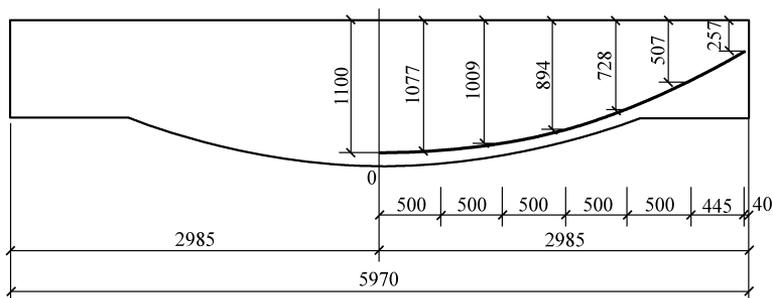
钢筋混凝土鱼腹式吊车梁主筋图
